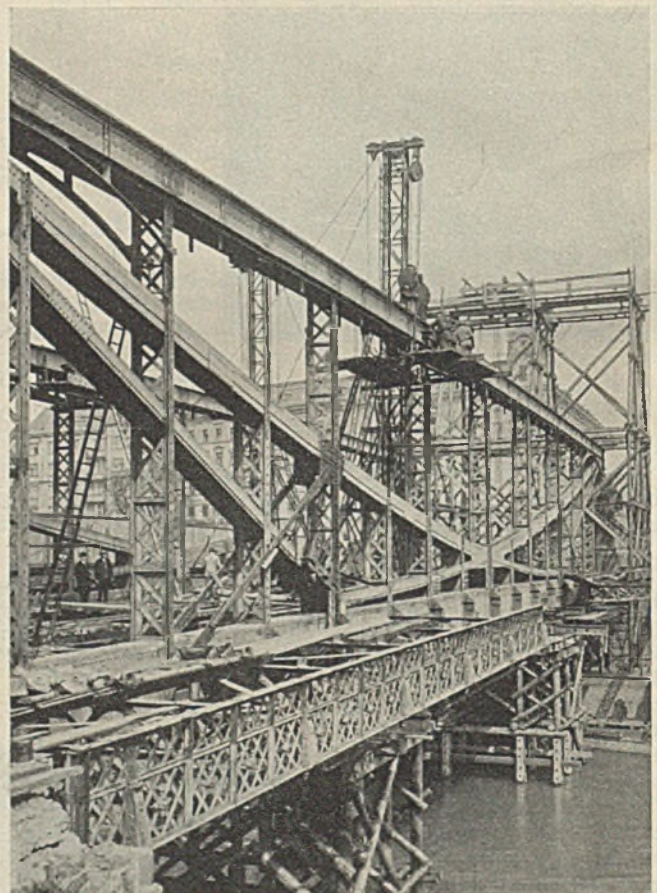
Das provisorische Zugband ist eingeführt, die untere Kette ist durchgeschnitten.
